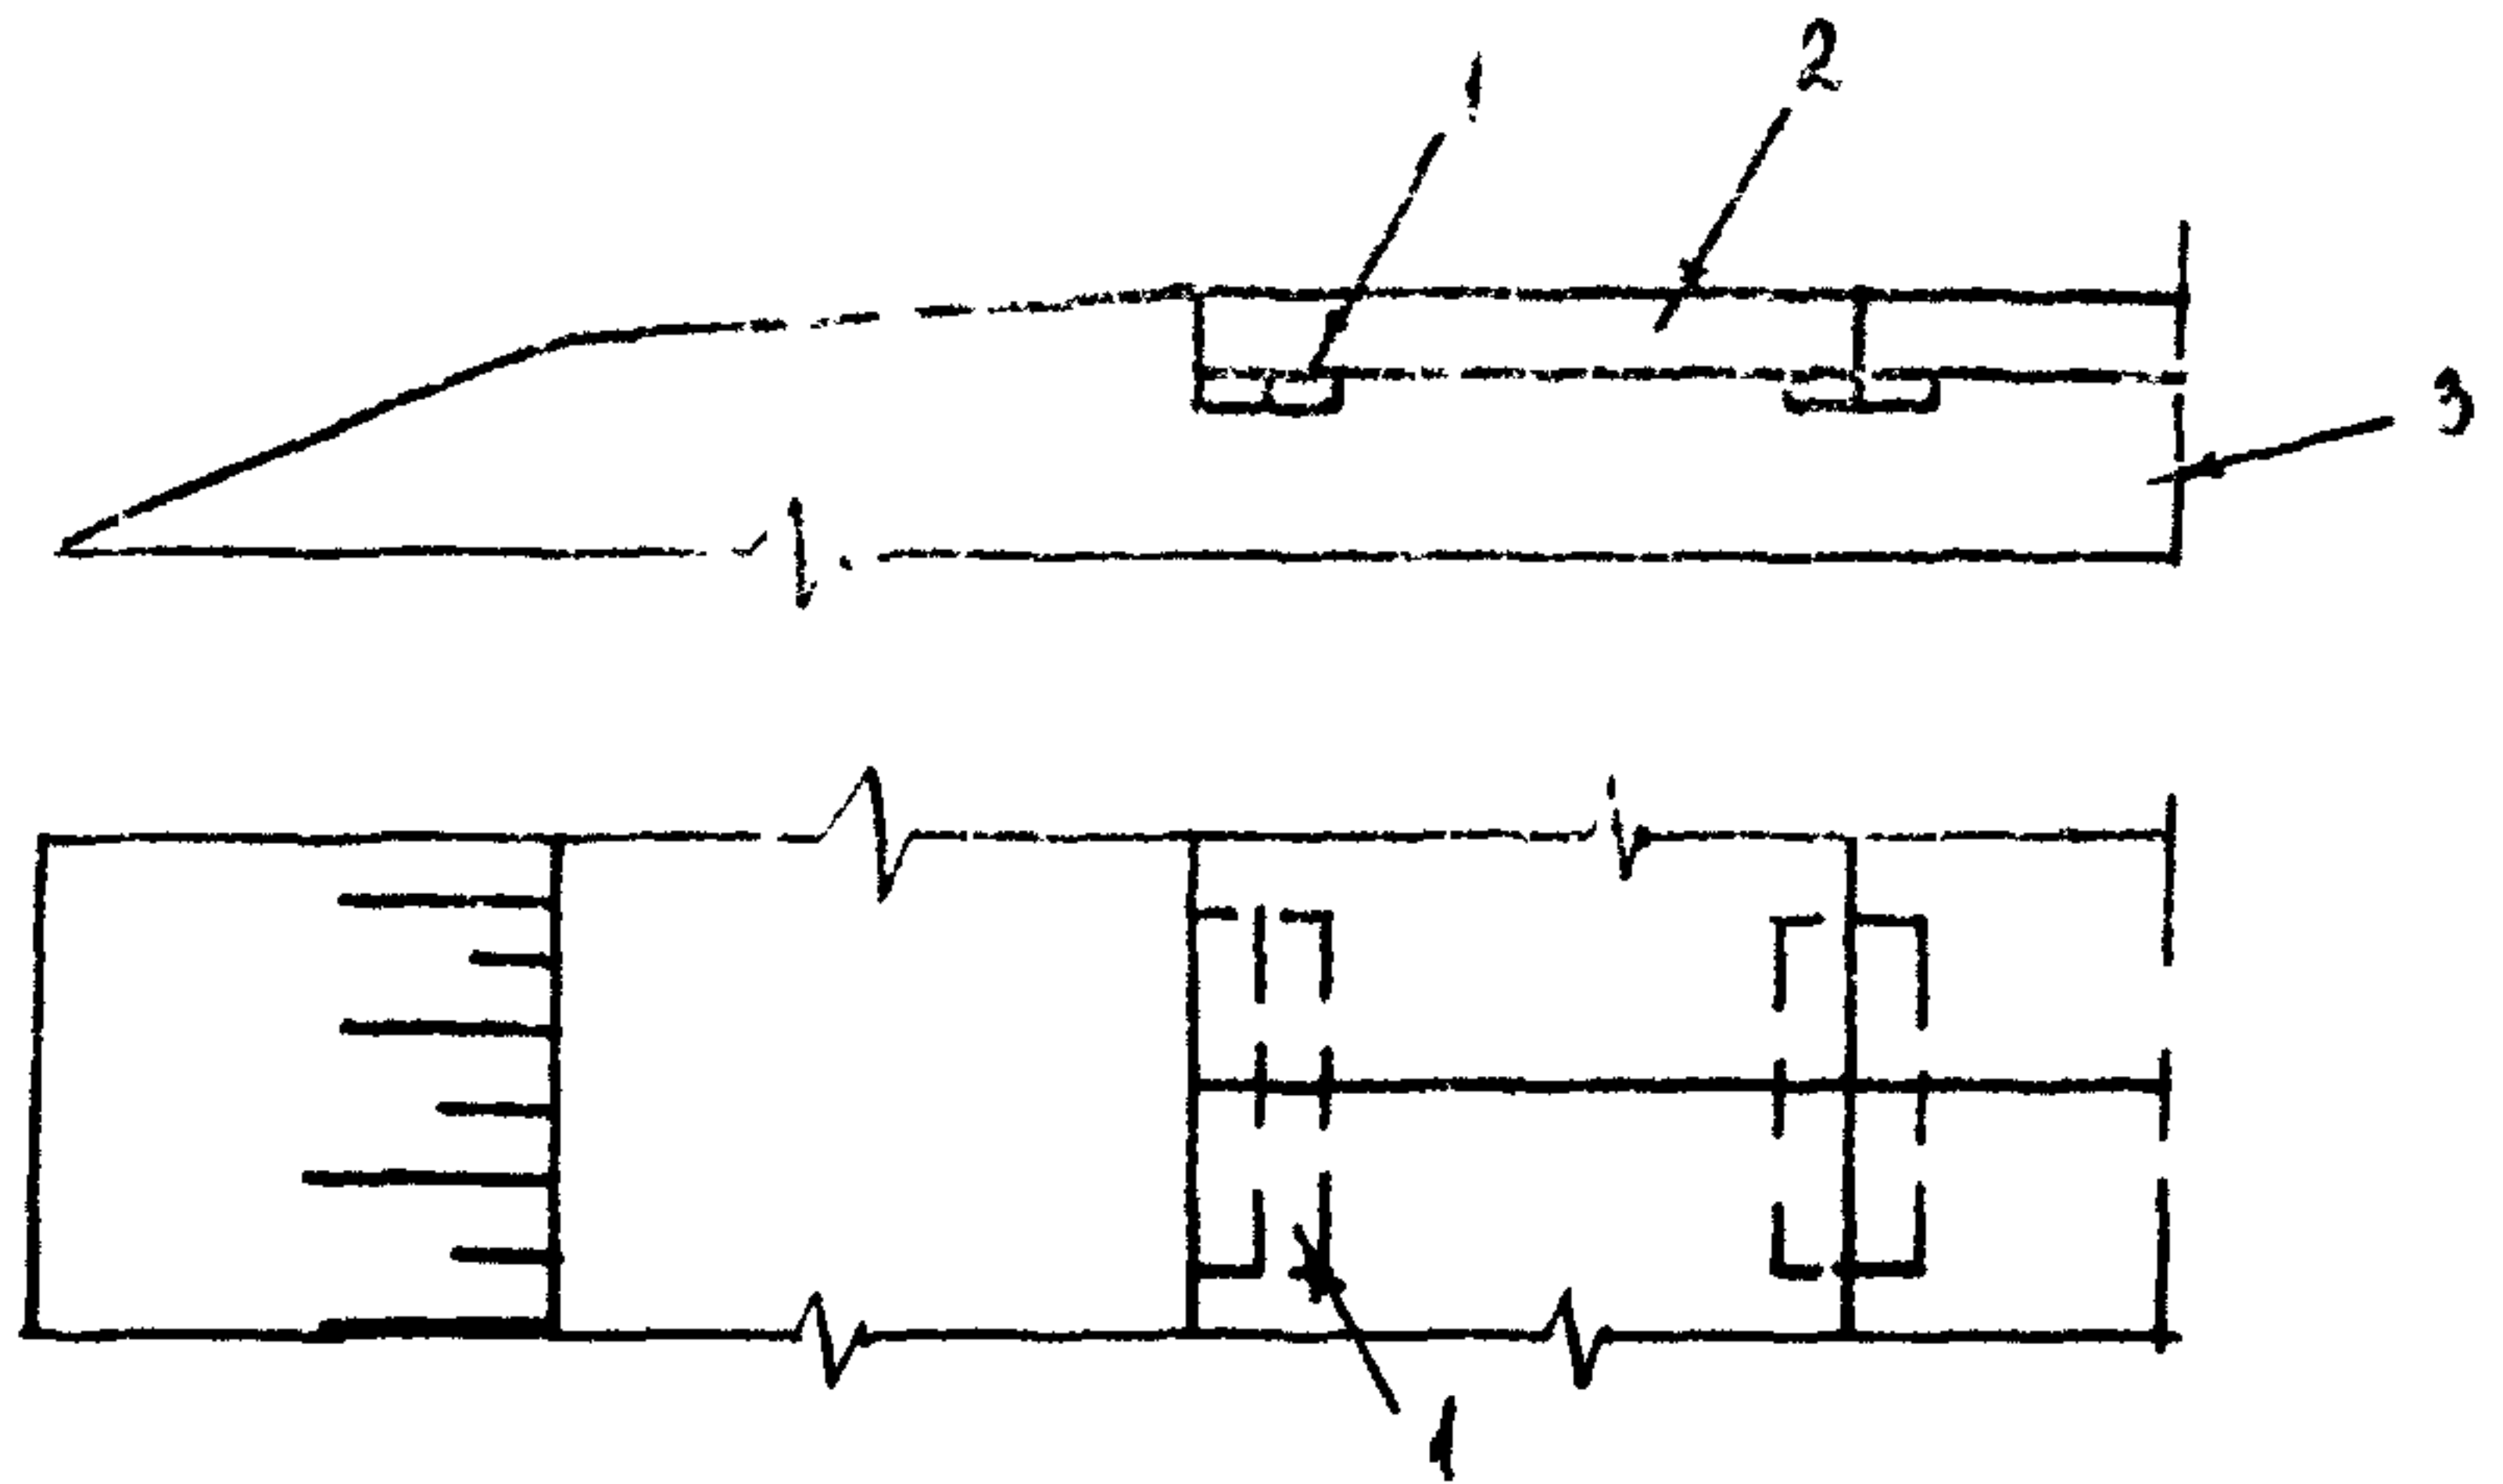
Сборное покрытие на неукрепленном основании с деревянными подкладками (размером $3 \times 15 \times 100$ см) под поперечными швами:
